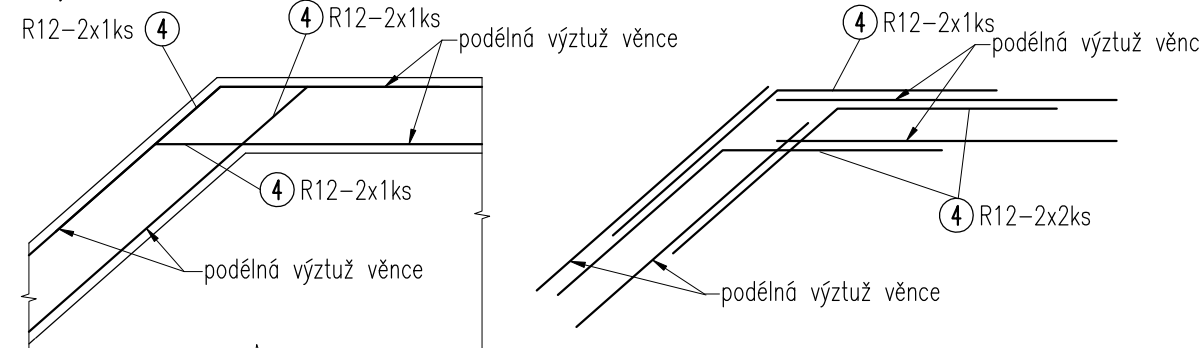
STYKOVÁNÍ PODÉLNÝCH PRUTŮ V KOLMÉM NAPOJENÍ VĚNCŮ, 4ks
